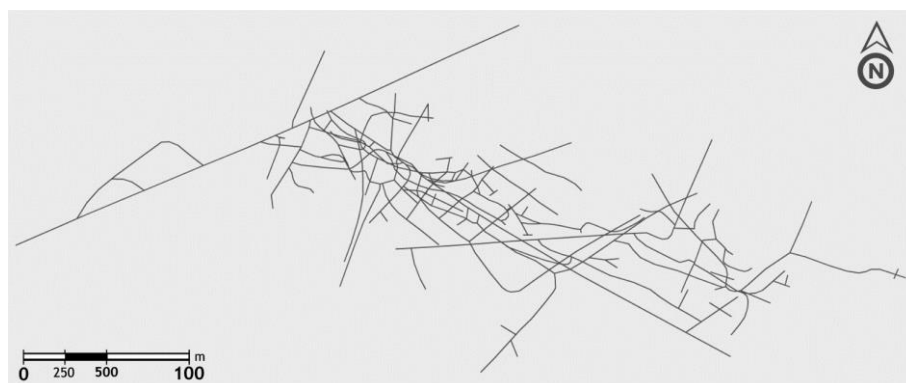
Planta das galerias da mina de Senhora da Guia
